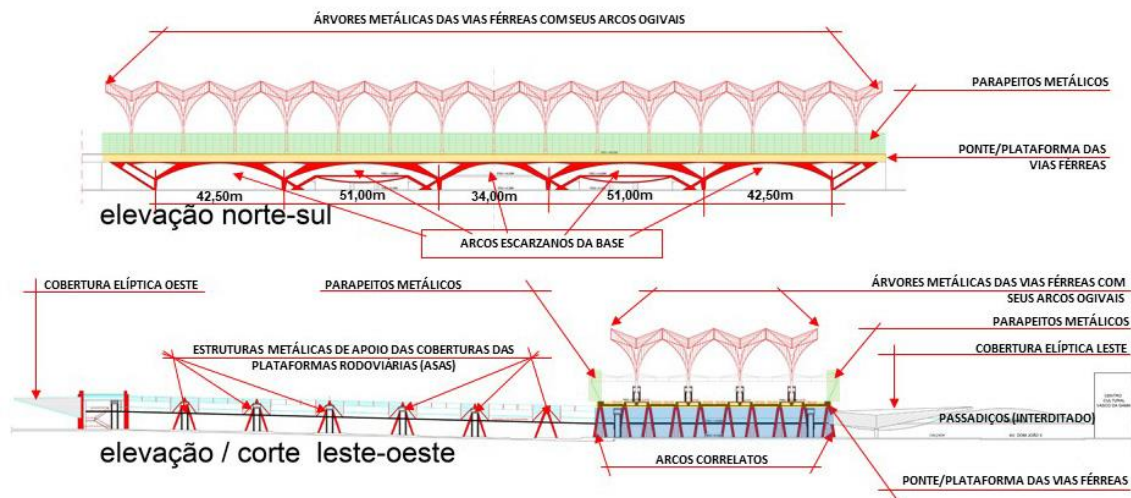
Elevações da Gare do Oriente – estruturas (redesenho do autor)
